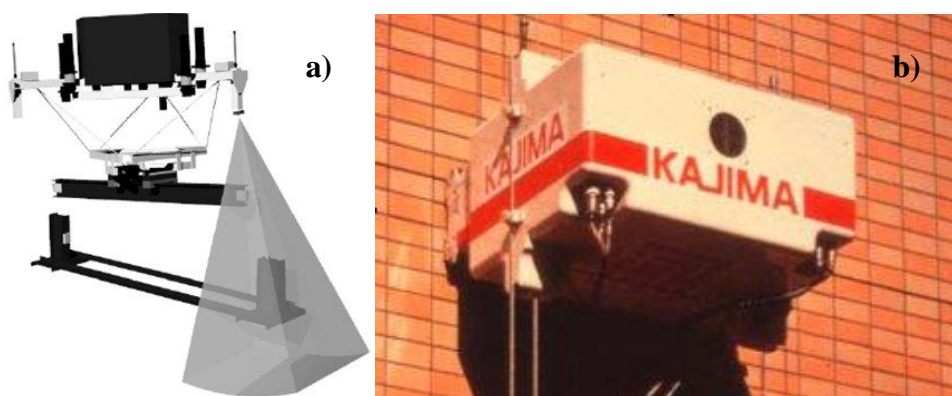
Robocrane (a), inspección de fachadas (b)
